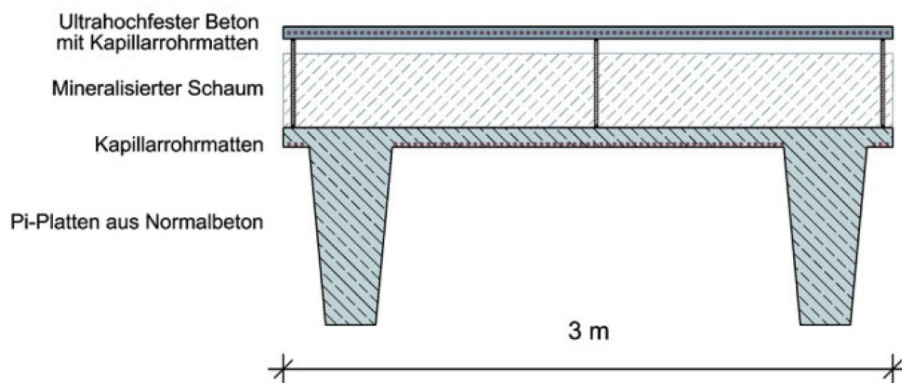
Querschnitt eines Hüllelements für Dach- und Wandbauteile aus Beton [2, S. 171]
